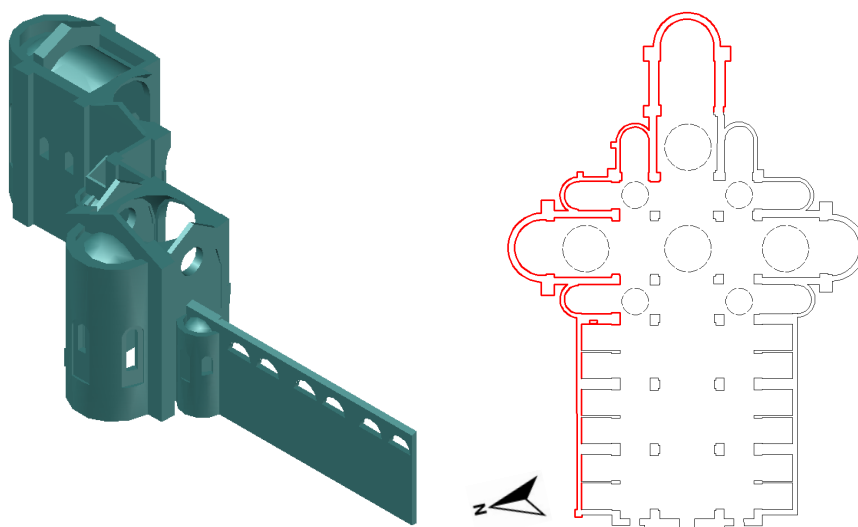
Vista assonometrica e pianta della fase 1 della struttura.
